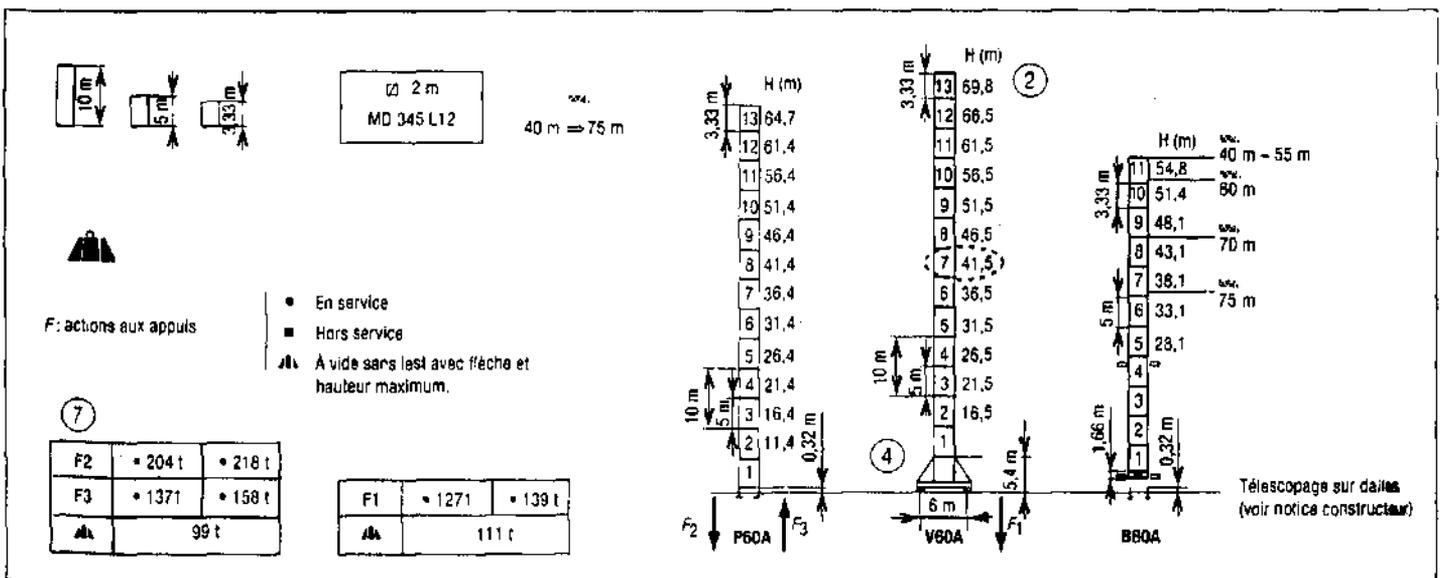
Caractéristiques dimensionnelles et actions aux appuis.
